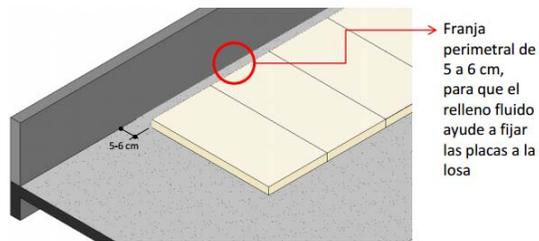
Procedimiento de instalación de aislamiento térmico en losas de concreto, vigueta y bovedilla
